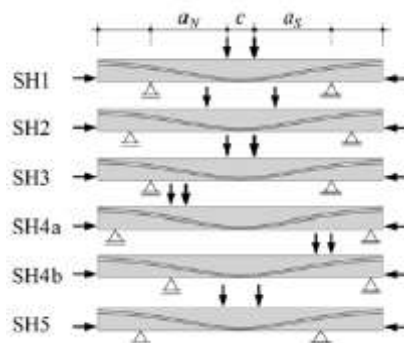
Disposição do carregamento para todas as vigas testadas [35].
